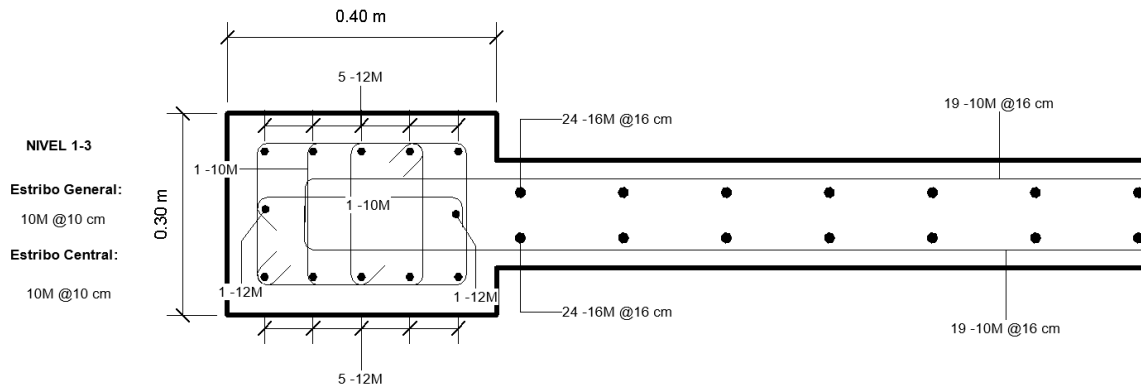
Secciones y armado de refuerzo cuando si se requiere elemento de borde para el sistema de 6 pisos
